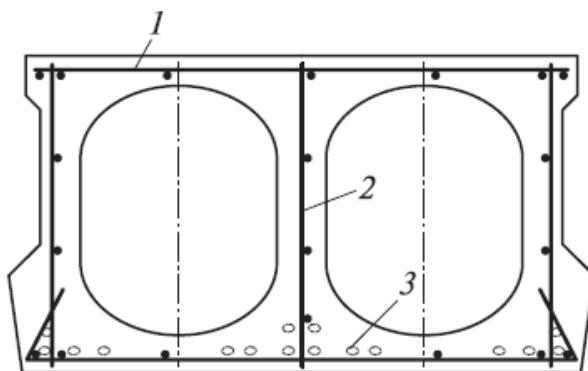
Армирование блока ненапрягаемой и напрягаемой арматурой:
